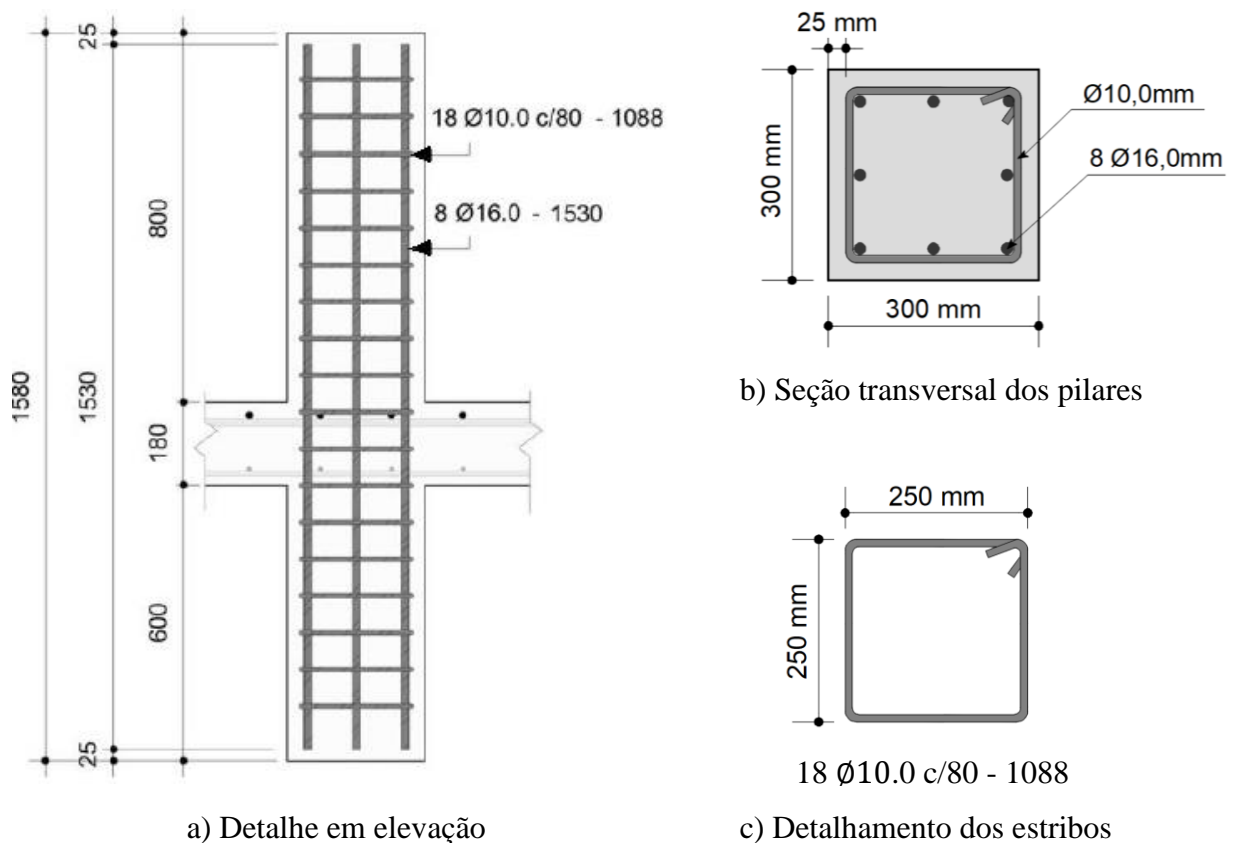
Detalhamento das armaduras longitudinais e transversais dos pilares (unidades em mm)
